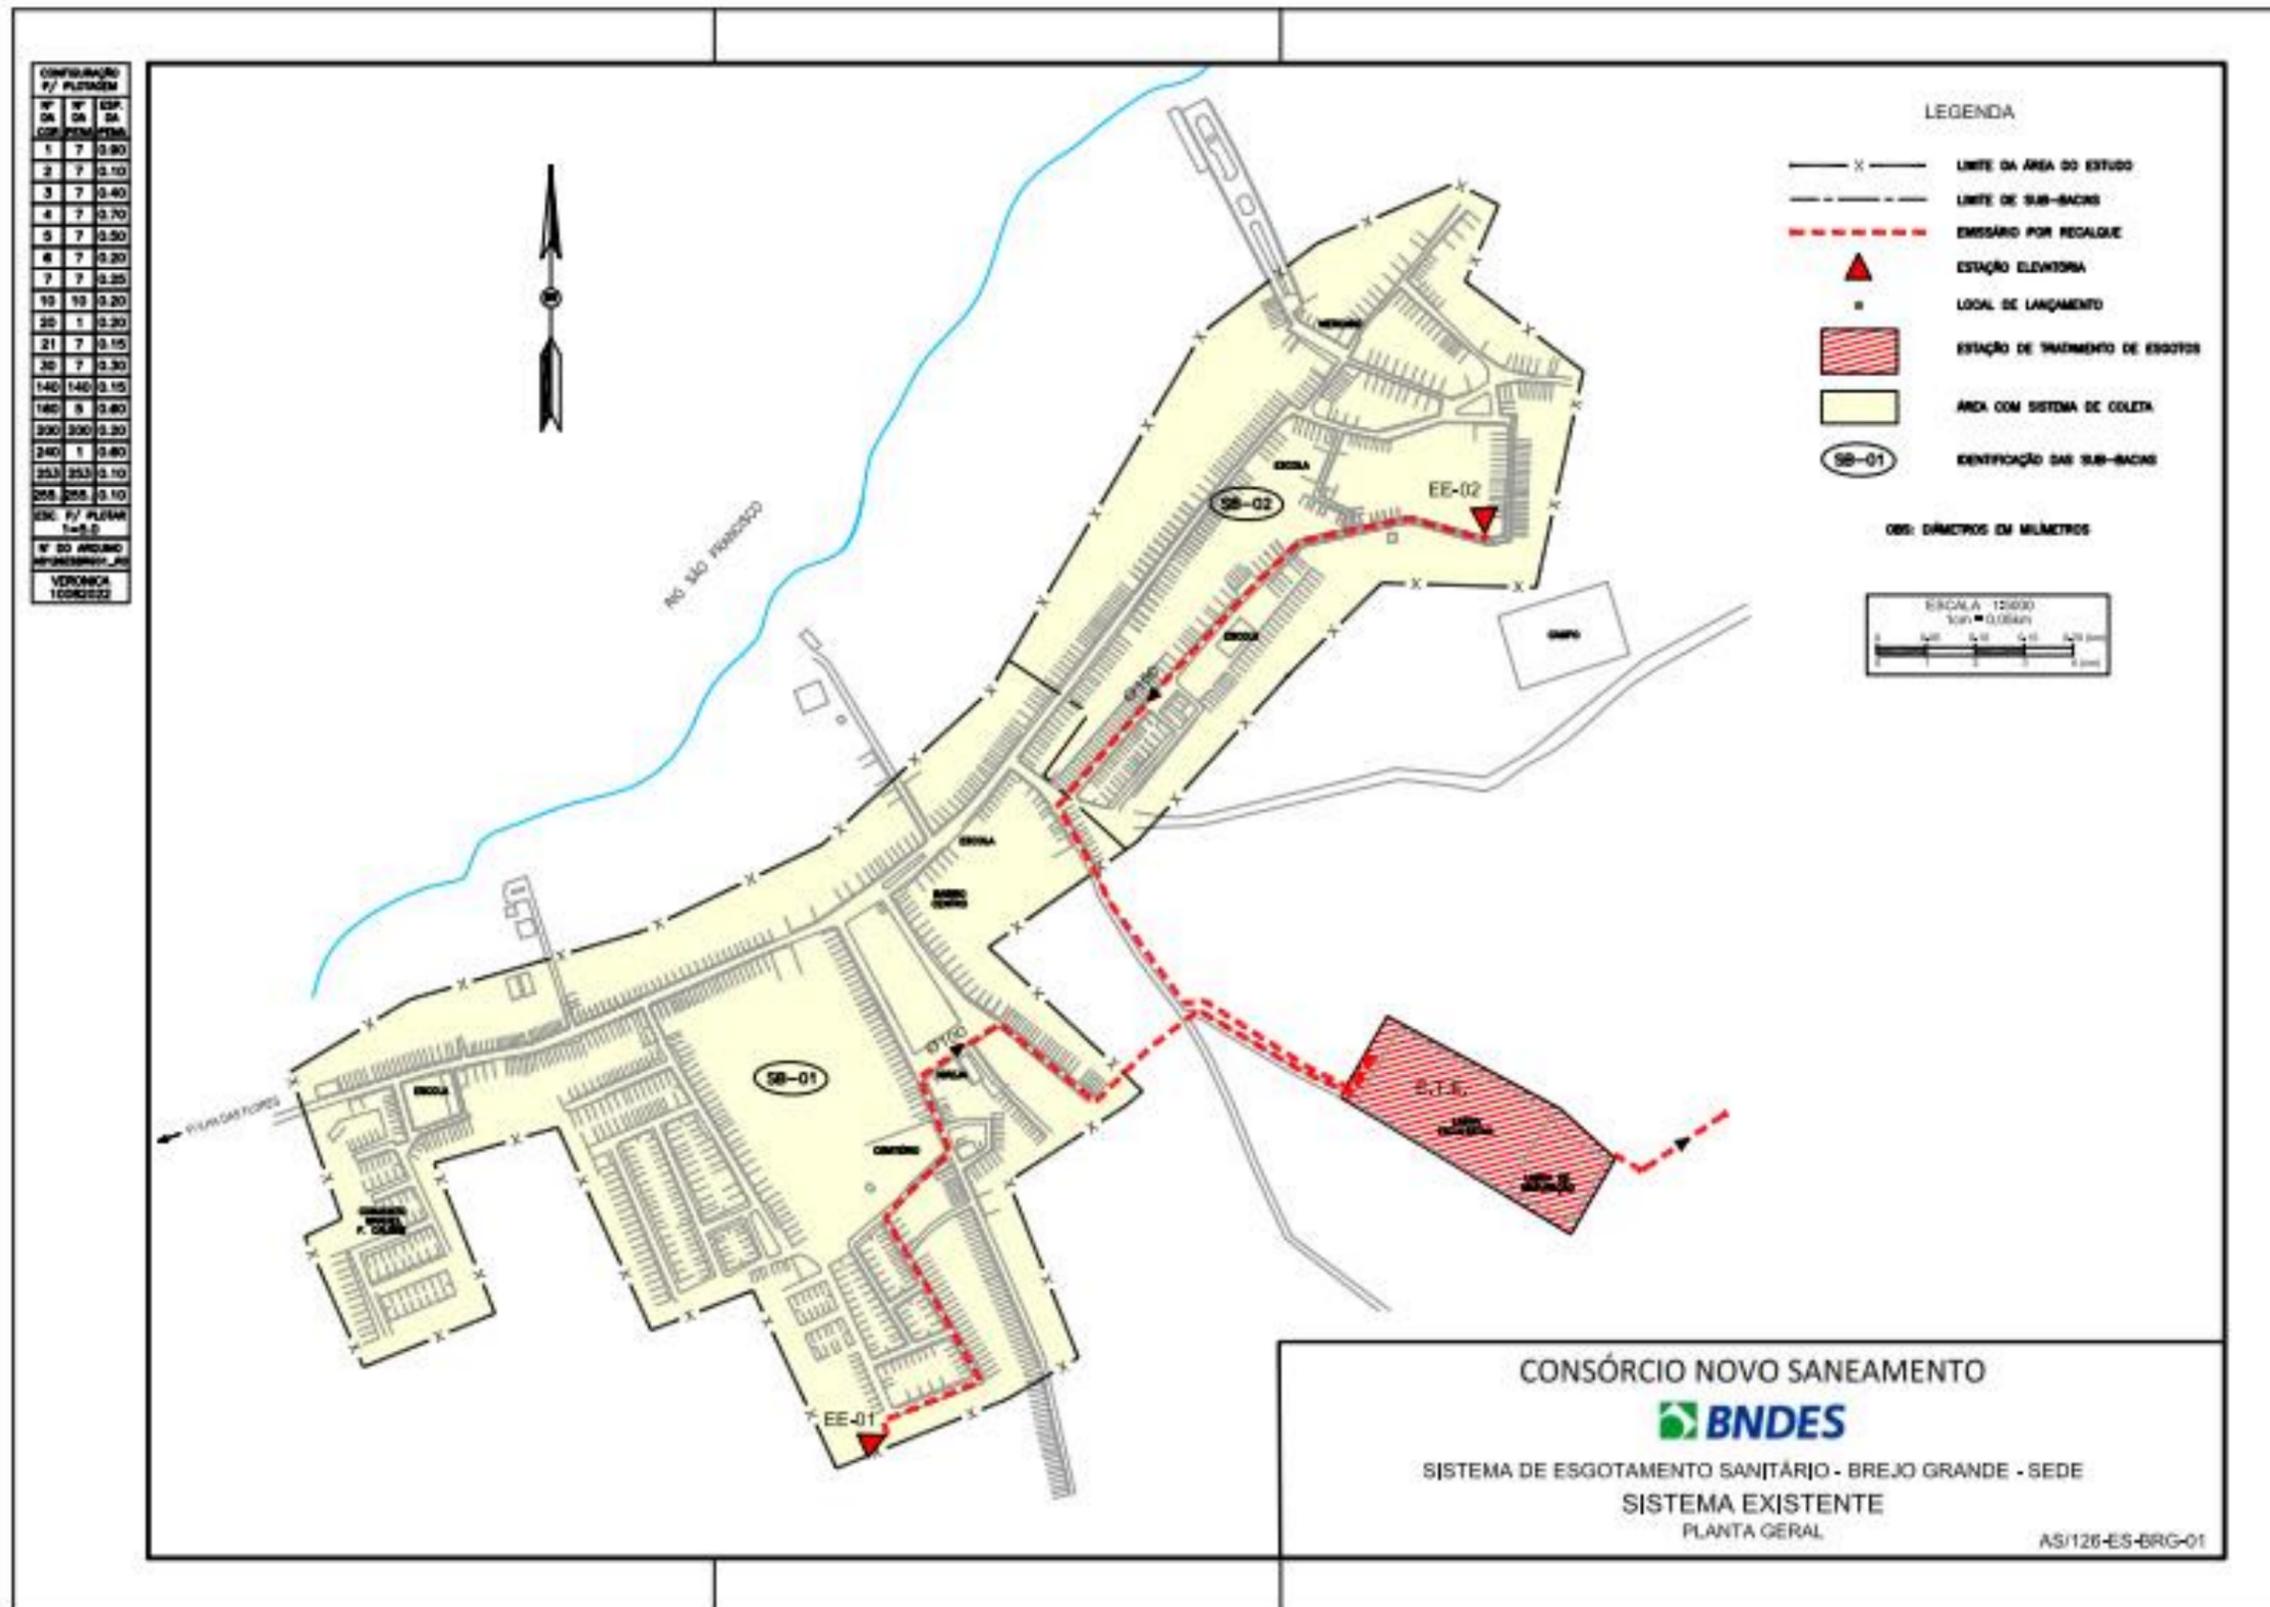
Planta do Sistema de Esgotamento Sanitário – BREJO GRANDE
